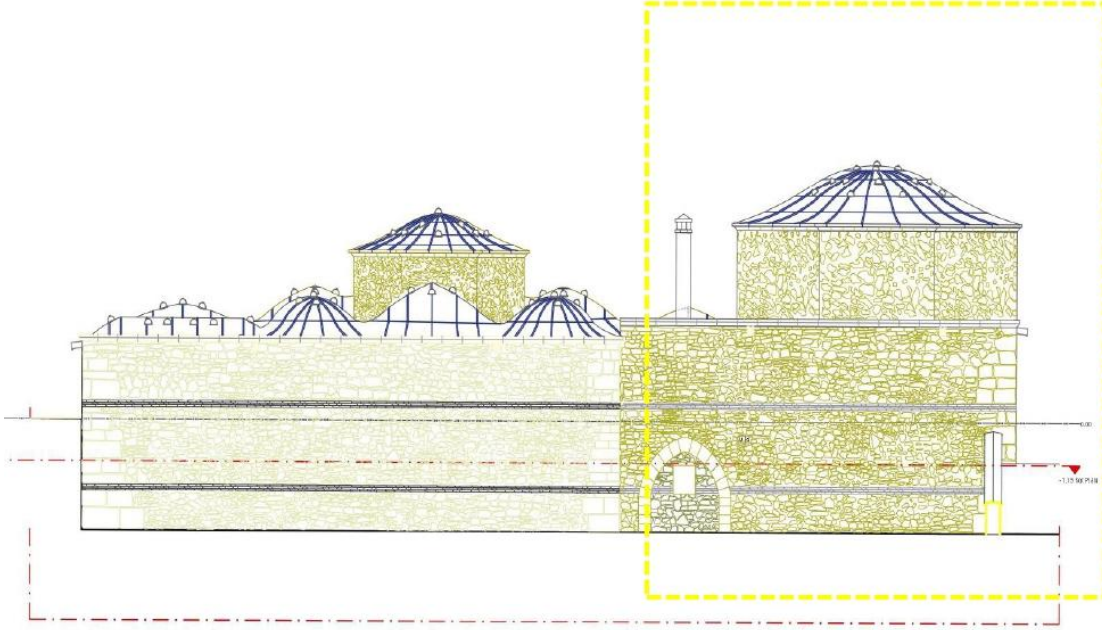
Başçavuş Hamamı 2-B Kesiti (Rölöve yazara aittir.)
